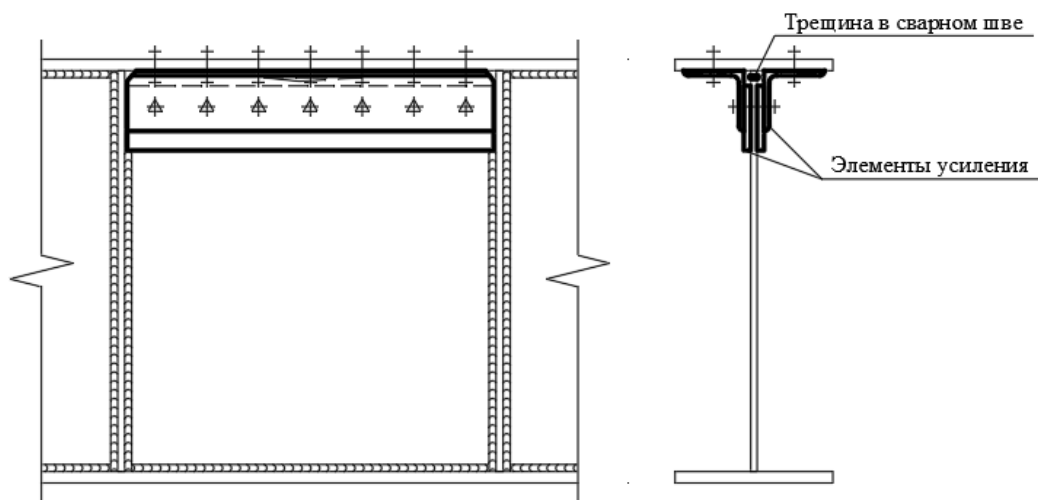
Конструктивное торможение развития усталостных трещин в стенке с установкой: усиливающих уголковых элементов с креплением высокопрочными болтами
